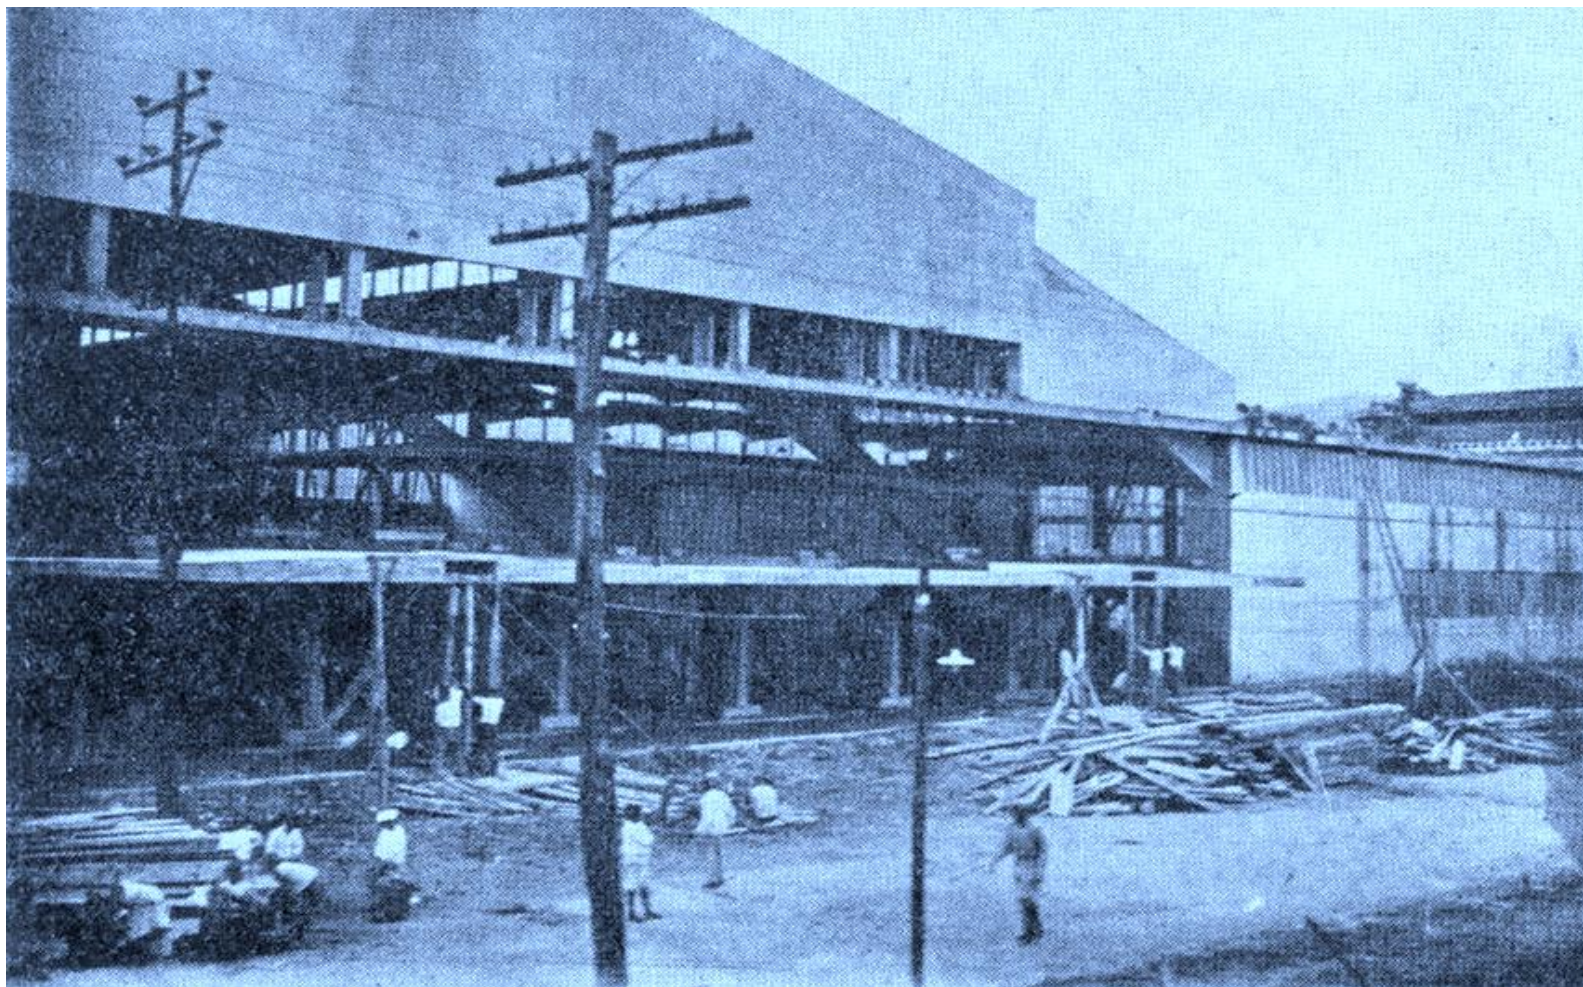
No Campo dos Afonsos, pela primeira vez no mundo, se executa uma porta de concreto armado para hangar. A fotografia mostra a porta que foi concretada horizontalmente no local onde seria utilizada, preparando-se para girar.
